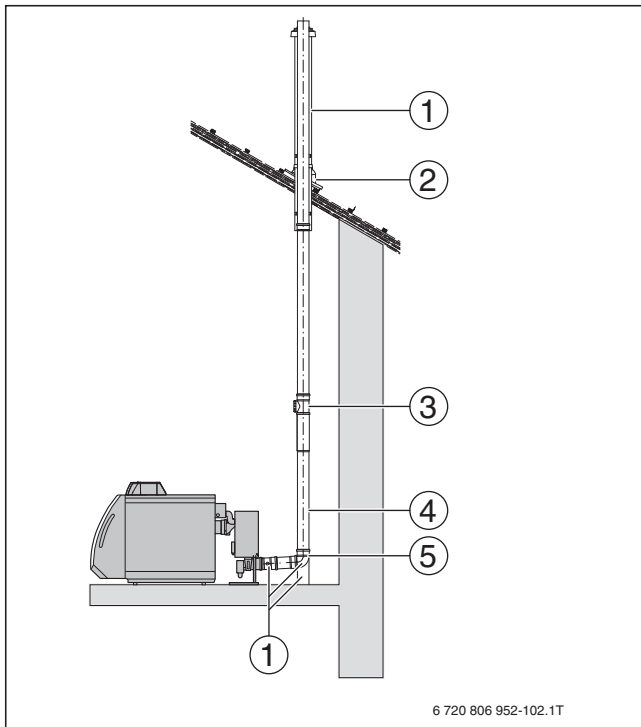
Abgasanlagen für Dachheizzentrale Variante 3
